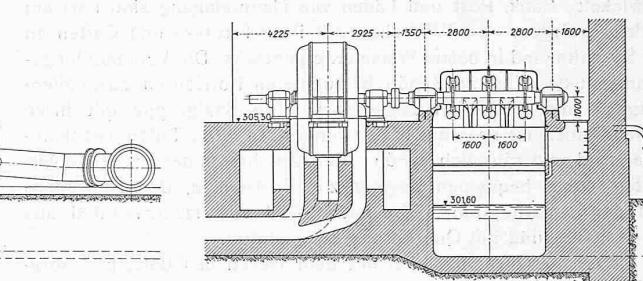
bis 3. Grundriss des Maschinensaals des Schwarzenbachwerks mit Ansicht der Gruppe I (JMV-Turbine) und Schnitt der EWC-Turbine — 1 : 300.
